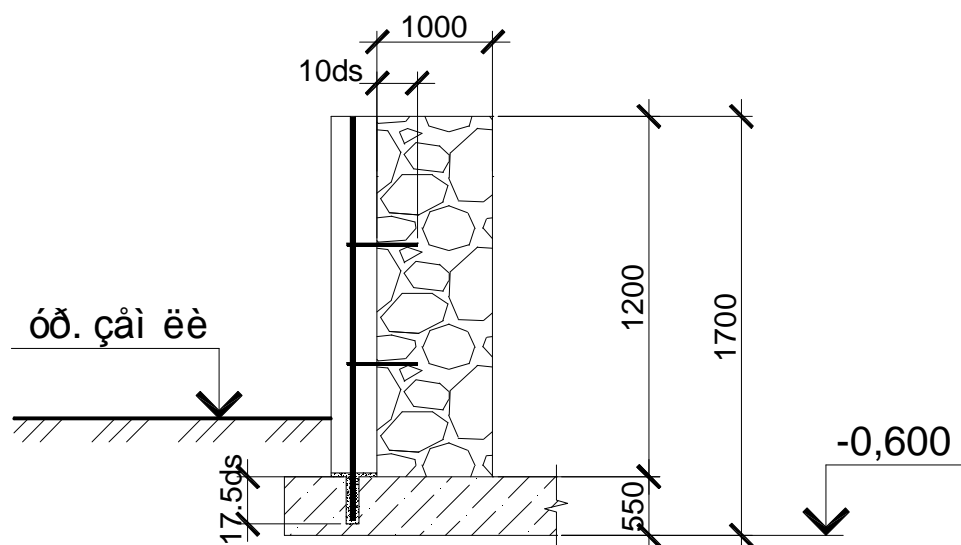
Схема ленточного фундамента реконструируемого жилого дома
